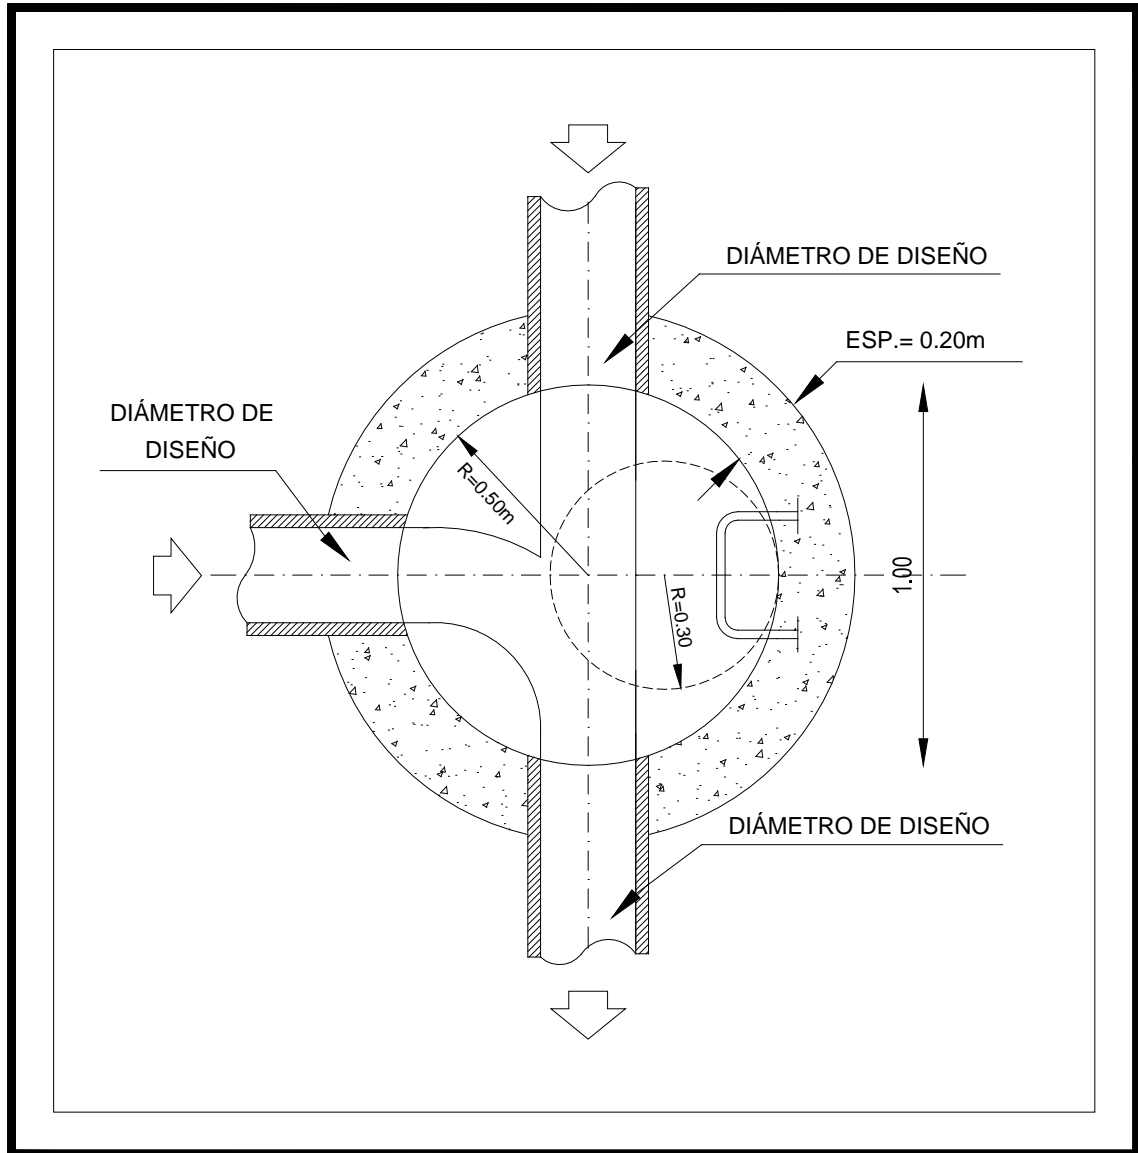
Vista en Planta de un Pozo con Dos Entradas y una Salida
